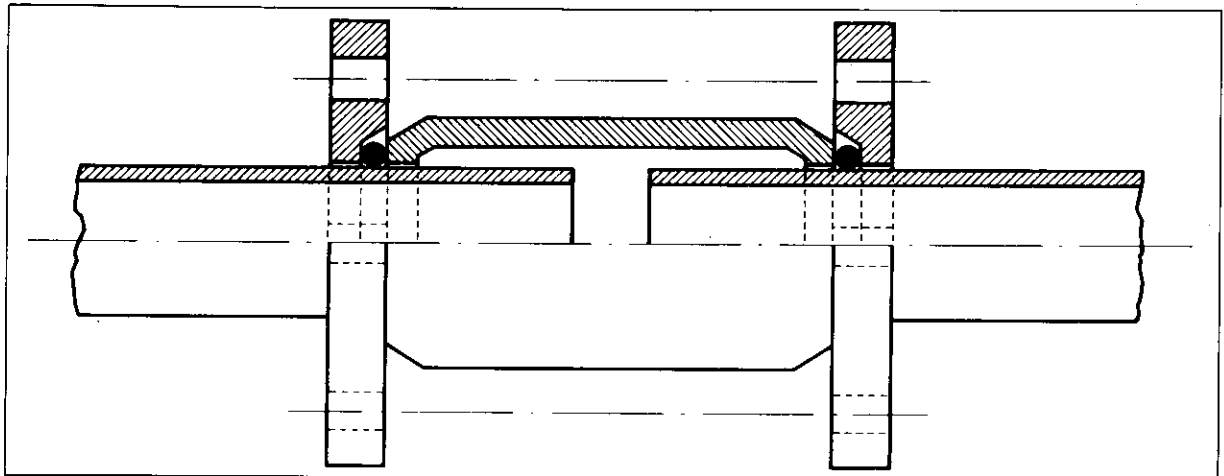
Giunto a serraggio meccanico «tipo Gibault»
